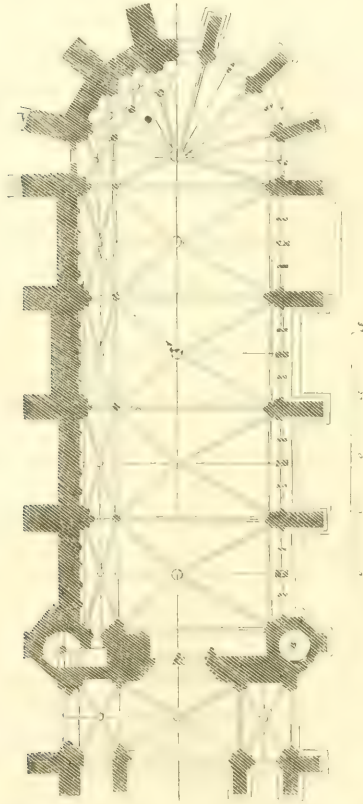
Ste. Chapelle zu Paris. Grundriss.
